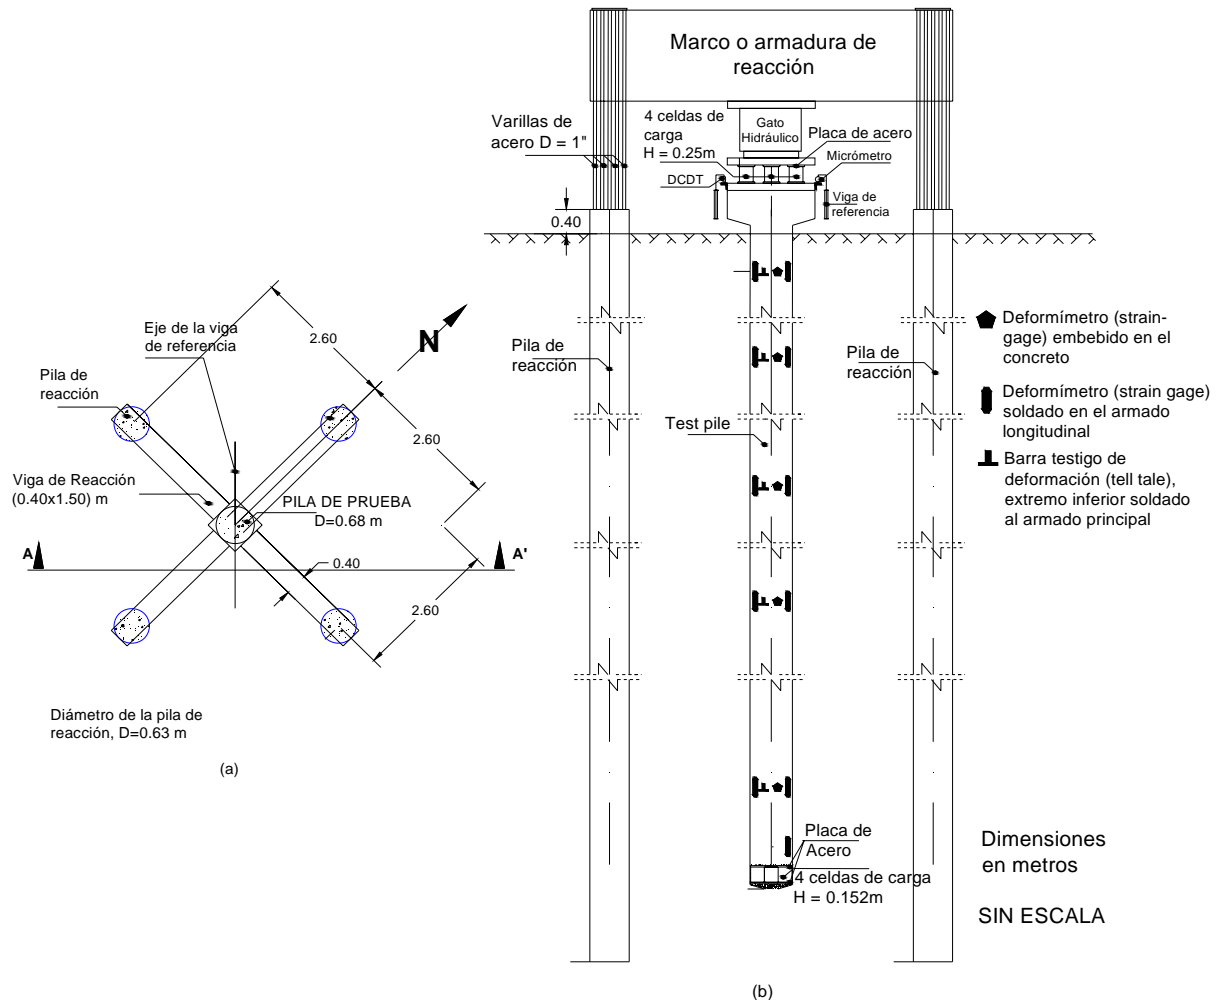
Arreglo para llevar a cabo la prueba de carga axial a) vista en planta y b) corte A-A'
